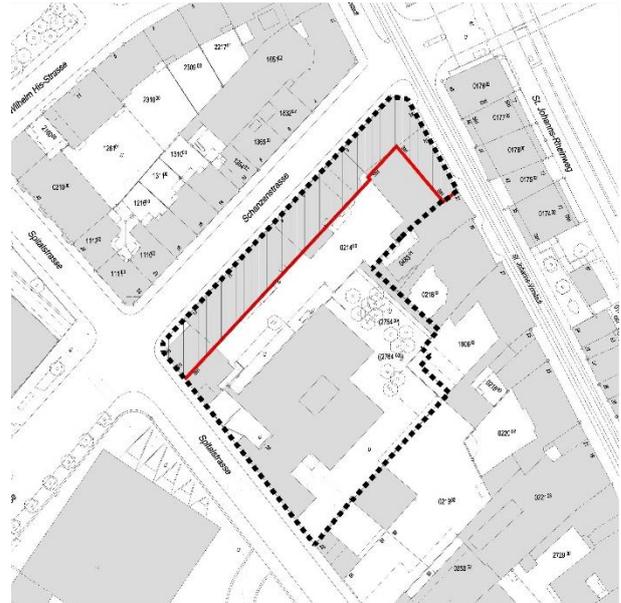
Situationsplan mit best. Bau- und Strassenlinie (rote Linie)
